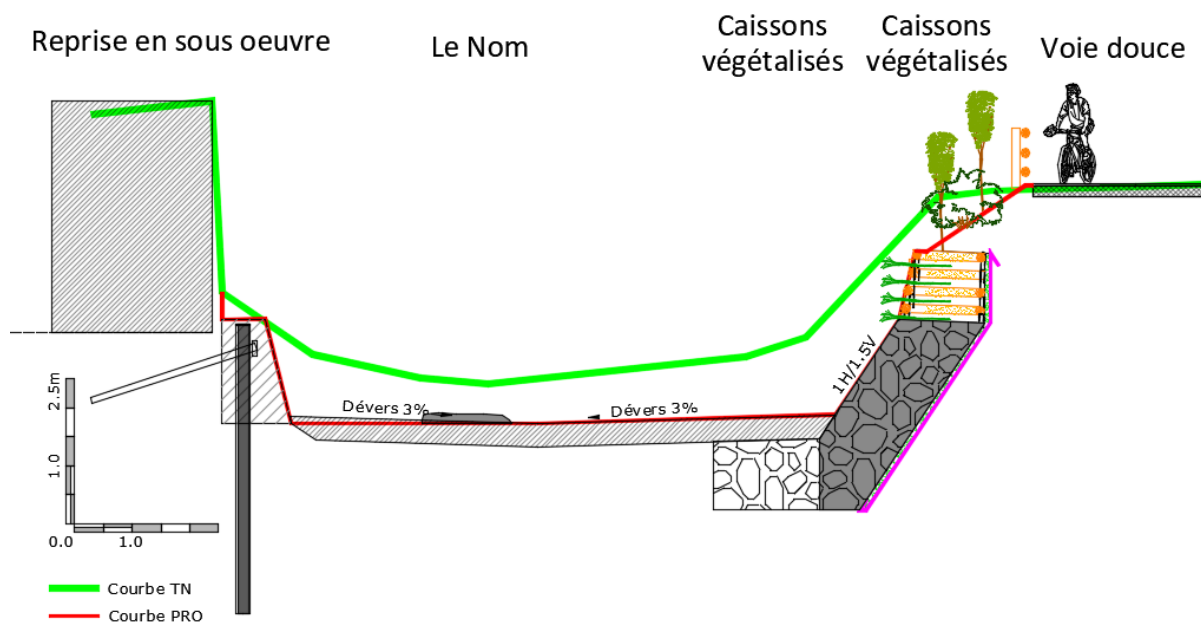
Coupe type de l'aménagement entre le Vieux Pont et le Pont Neuf (hors seuil)
